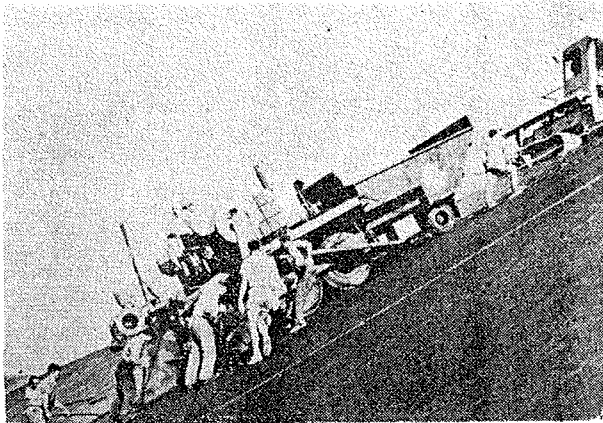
Posa in opera del rivestimento impermeabile sul paramento di monte del rilevato.
